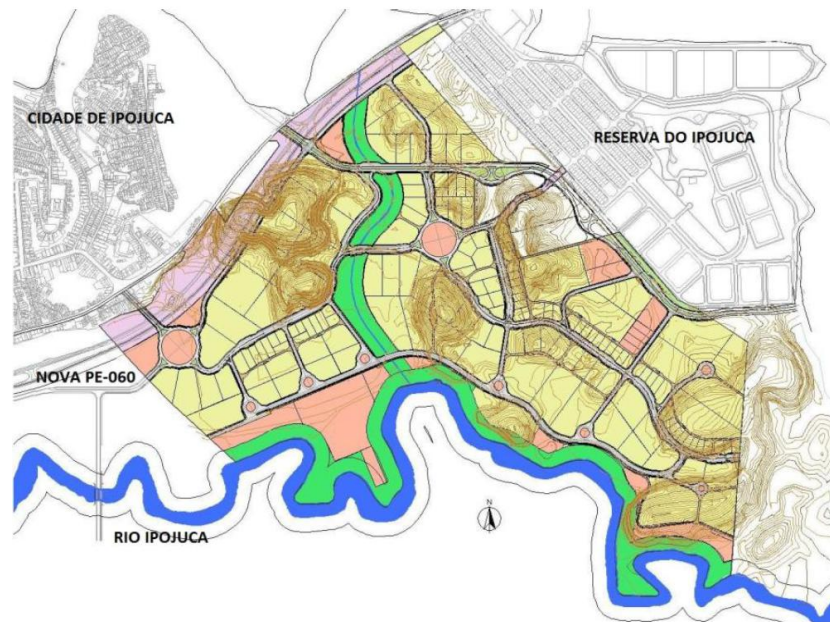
Plano Urbanístico loteamento Engenho Trapiche
